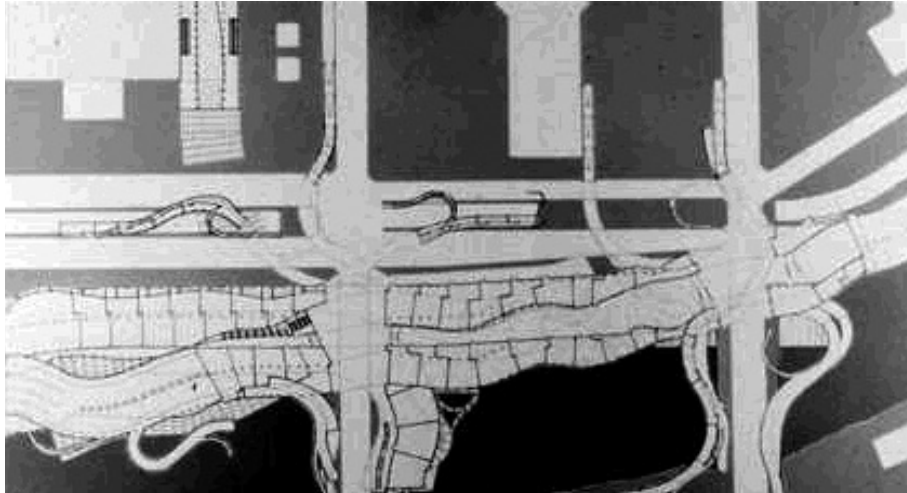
Greg Lynn, Stranded Sears Tower, Chicago/Illinois, USA, Entwurf 1992. Grundriss des Erdgeschosses mit Umgebung.
